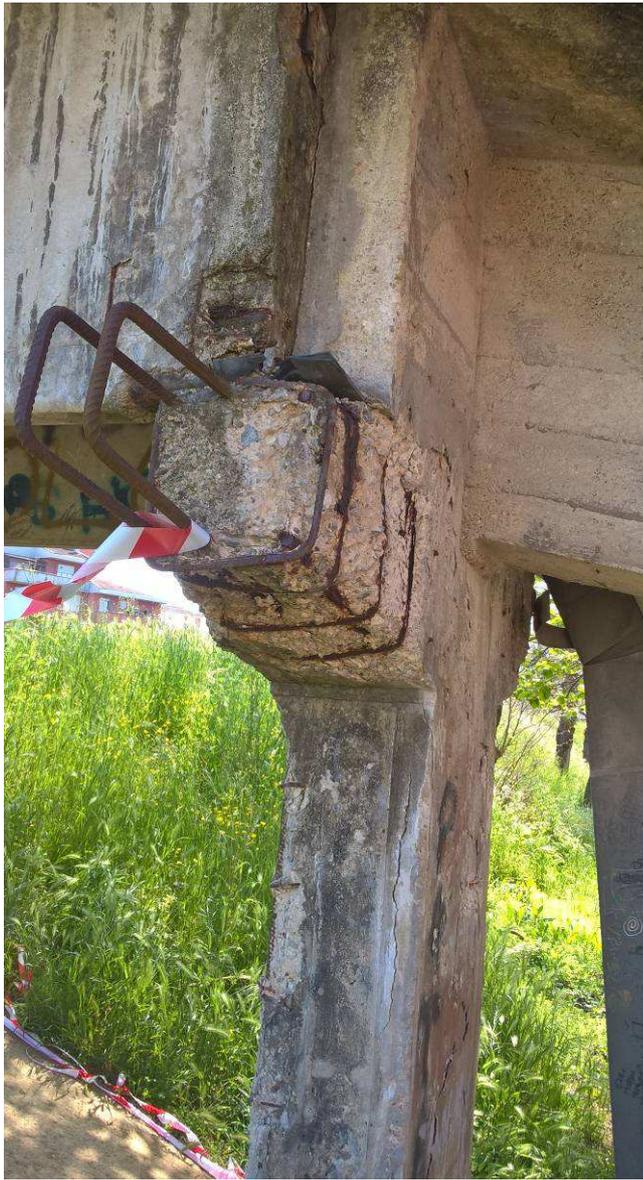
Dettaglio del degrado su una delle mensole della spalla nord (lato via Trento)
